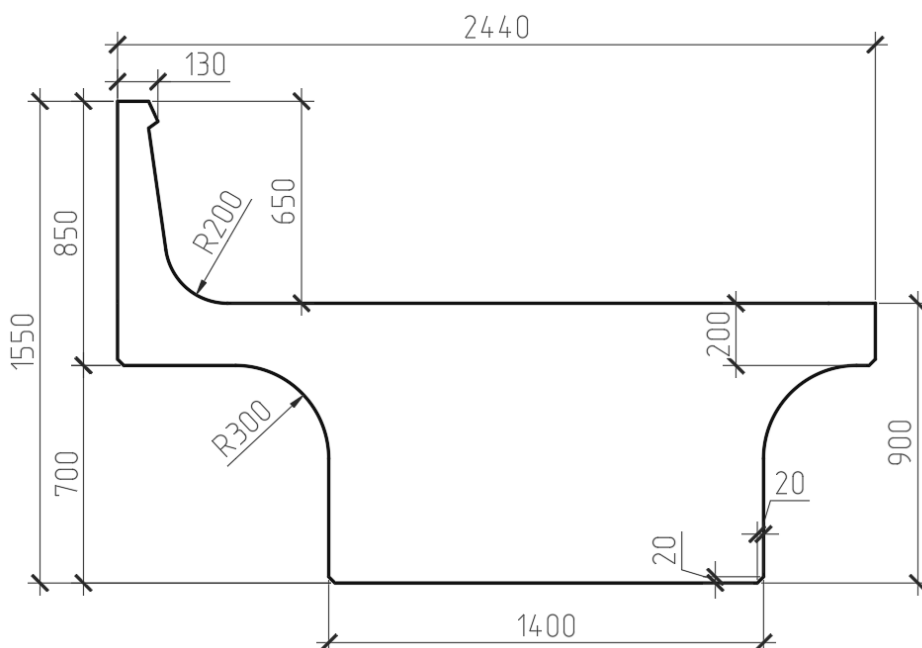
Переріз блоку прогонової будови за опалубкою
